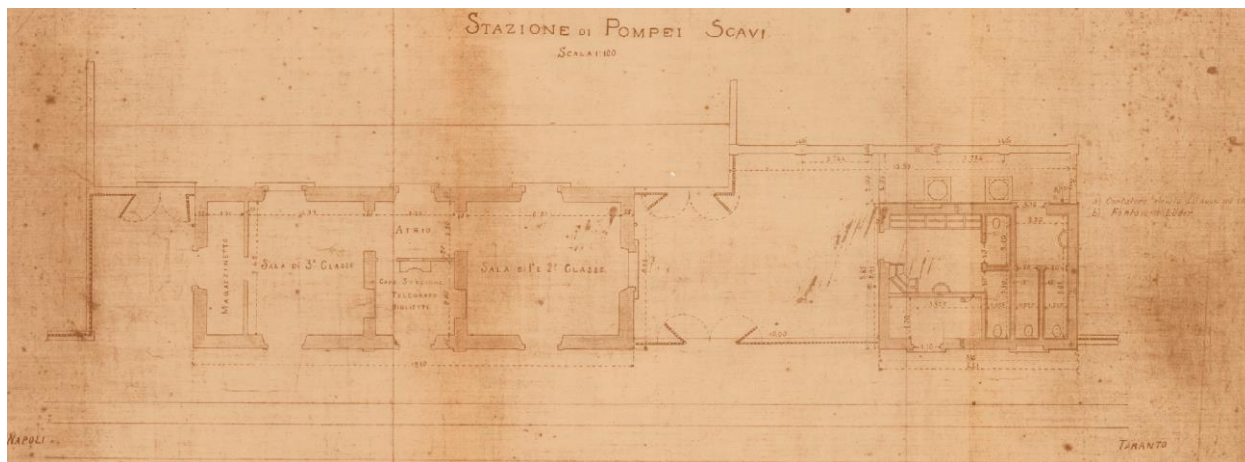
planimetria dei fabbricati della Ex fermata di Pompei scavi - fonte archivio storico FS
